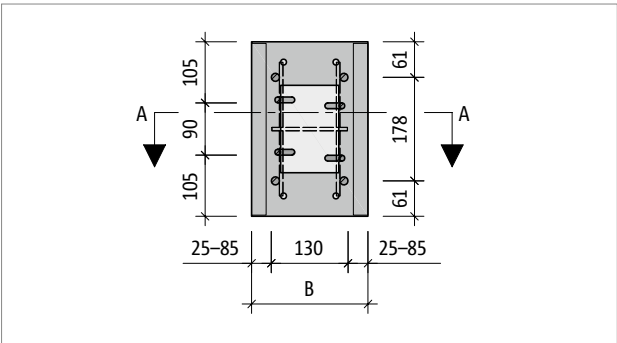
Schöck Sconnex® Typ W-NT1T1-V1H1: Produktgrundriss
